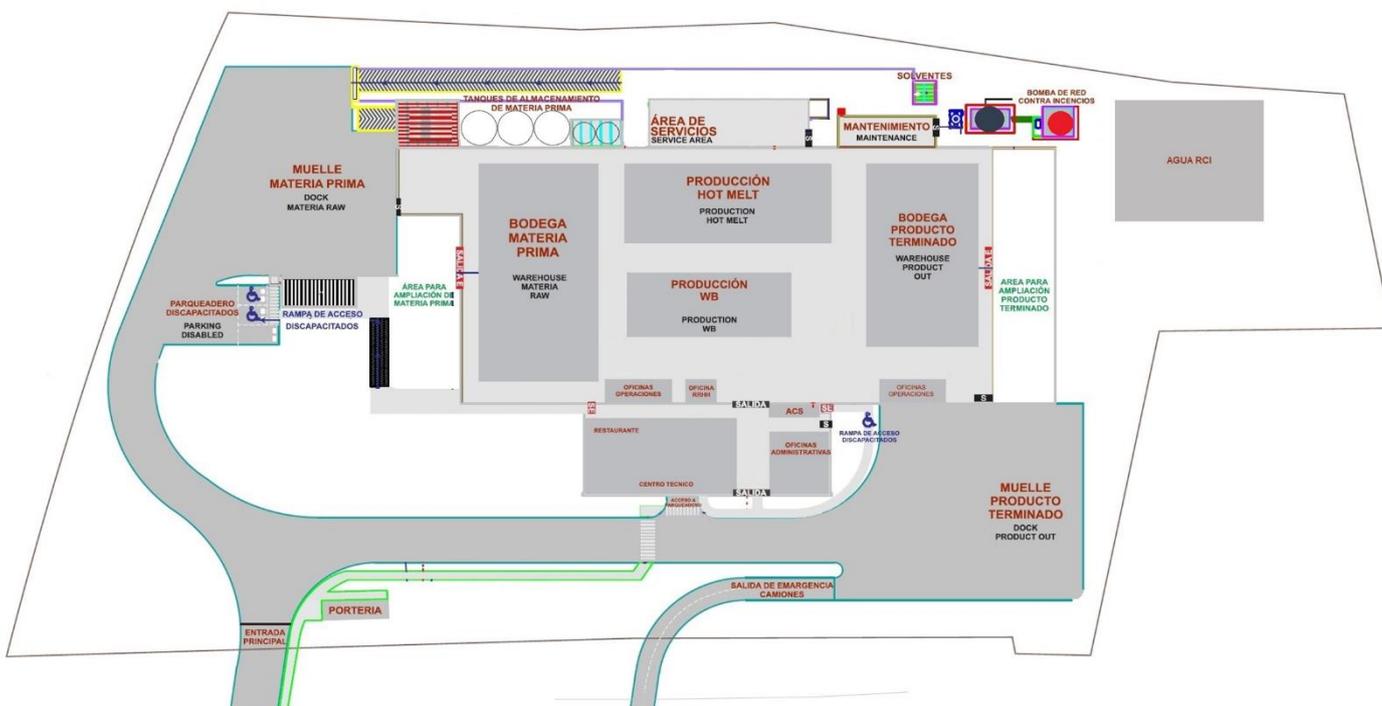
Plano de la planta HB Fuller Colombia S.A.S.
